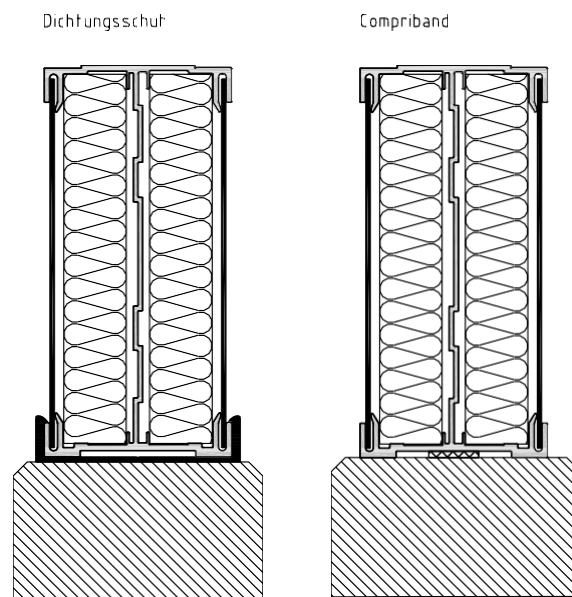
Auflagerung auf Sockelelementen aus Stahlbeton
